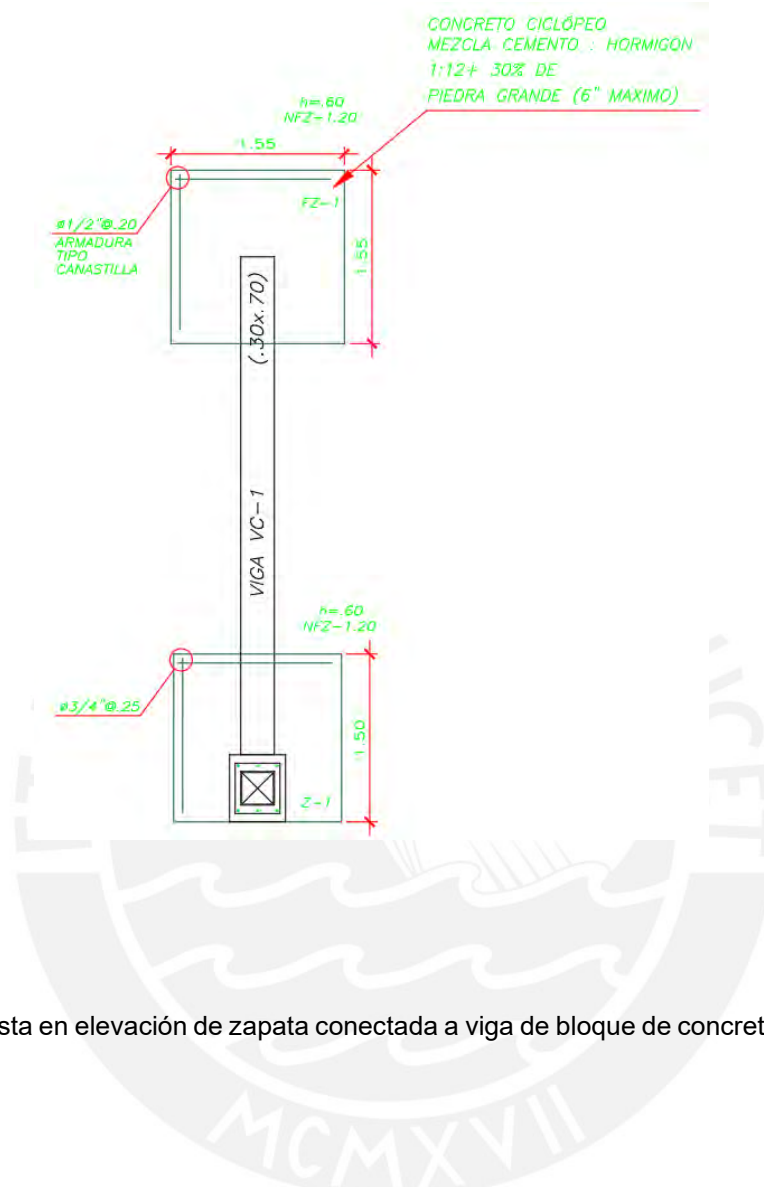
Vista en elevación de zapata conectada a viga de bloque de concreto (Fuente: Propia)
